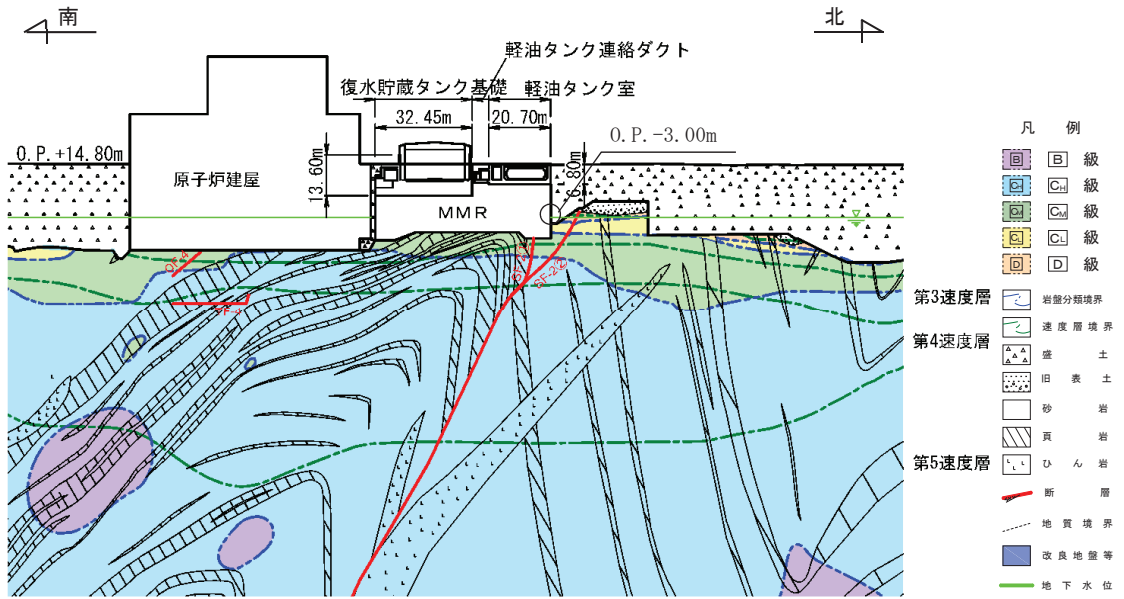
復水貯蔵タンク基礎 地震時荷重算出用地質断面図 (A-A 断面, 南北)
